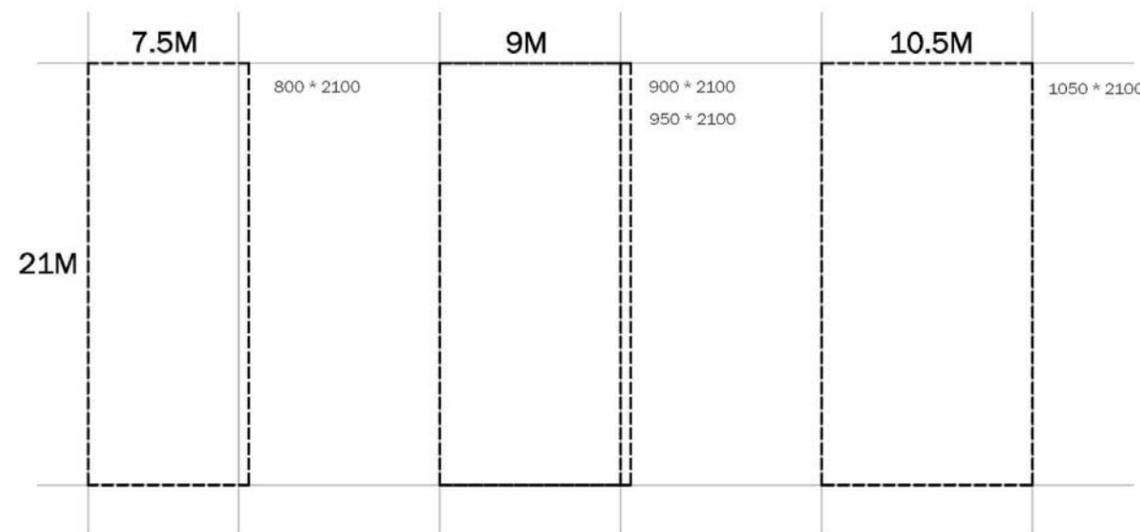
Ilustración de dimensiones de puertas utilizadas por la Empresa A
